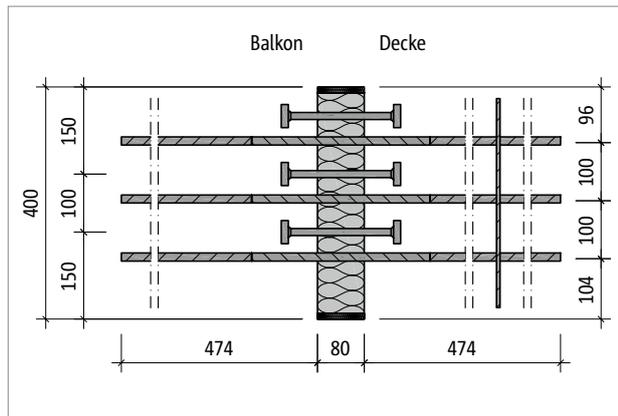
Schöck Isokorb® T Typ Q-P-V9: Produktgrundriss
